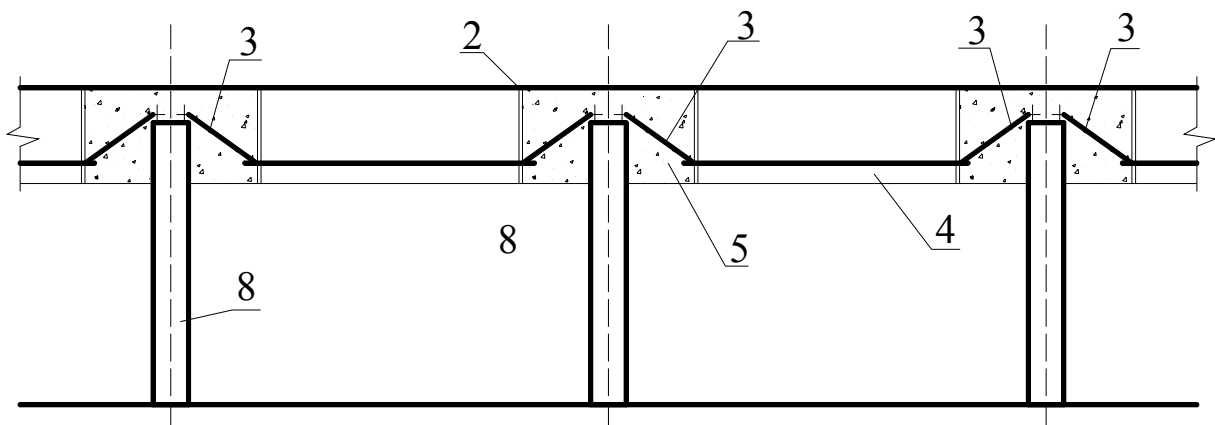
Пальовий фундамент: 1– палі; 2– збірно–монолітний ростверк; 3– випуски арматури; 4– збірні елементи; 5– монолітний стик
